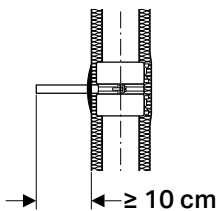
Detail Fixpunkt für einbetonierte gedämmte Geberit PE Leitungen
